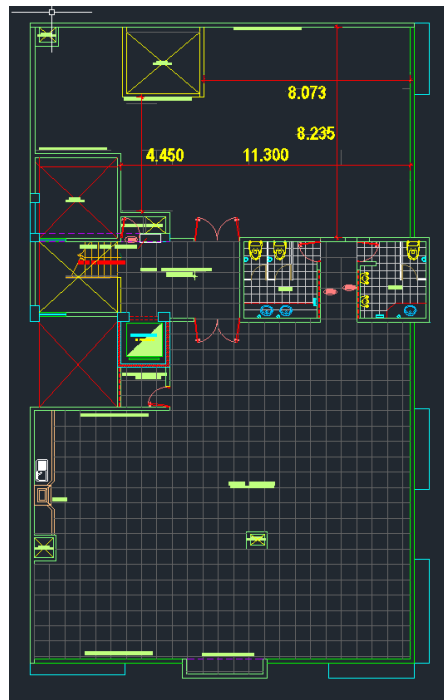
Vista en Planta de la Terraza (Elaboración propia)
